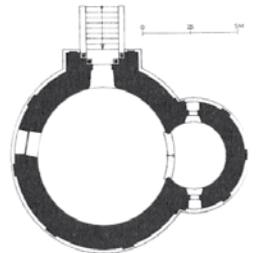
Grundriss Dehio NÖ 1990, 742. M 1:400.
